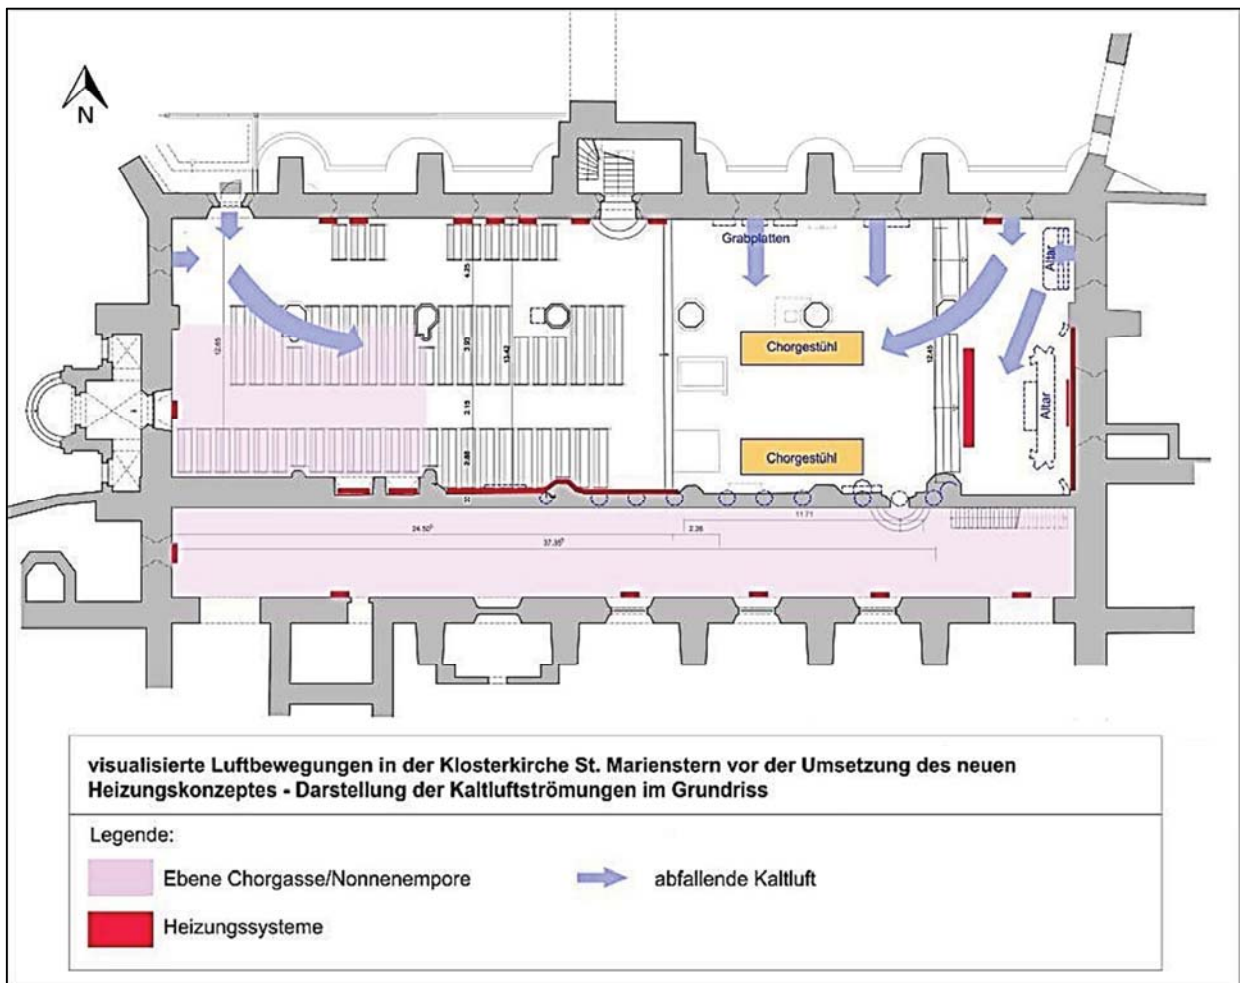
Schematische Darstellung der Zuglufterscheinungen im Grundriss / Voruntersuchung 2007 – 2008
